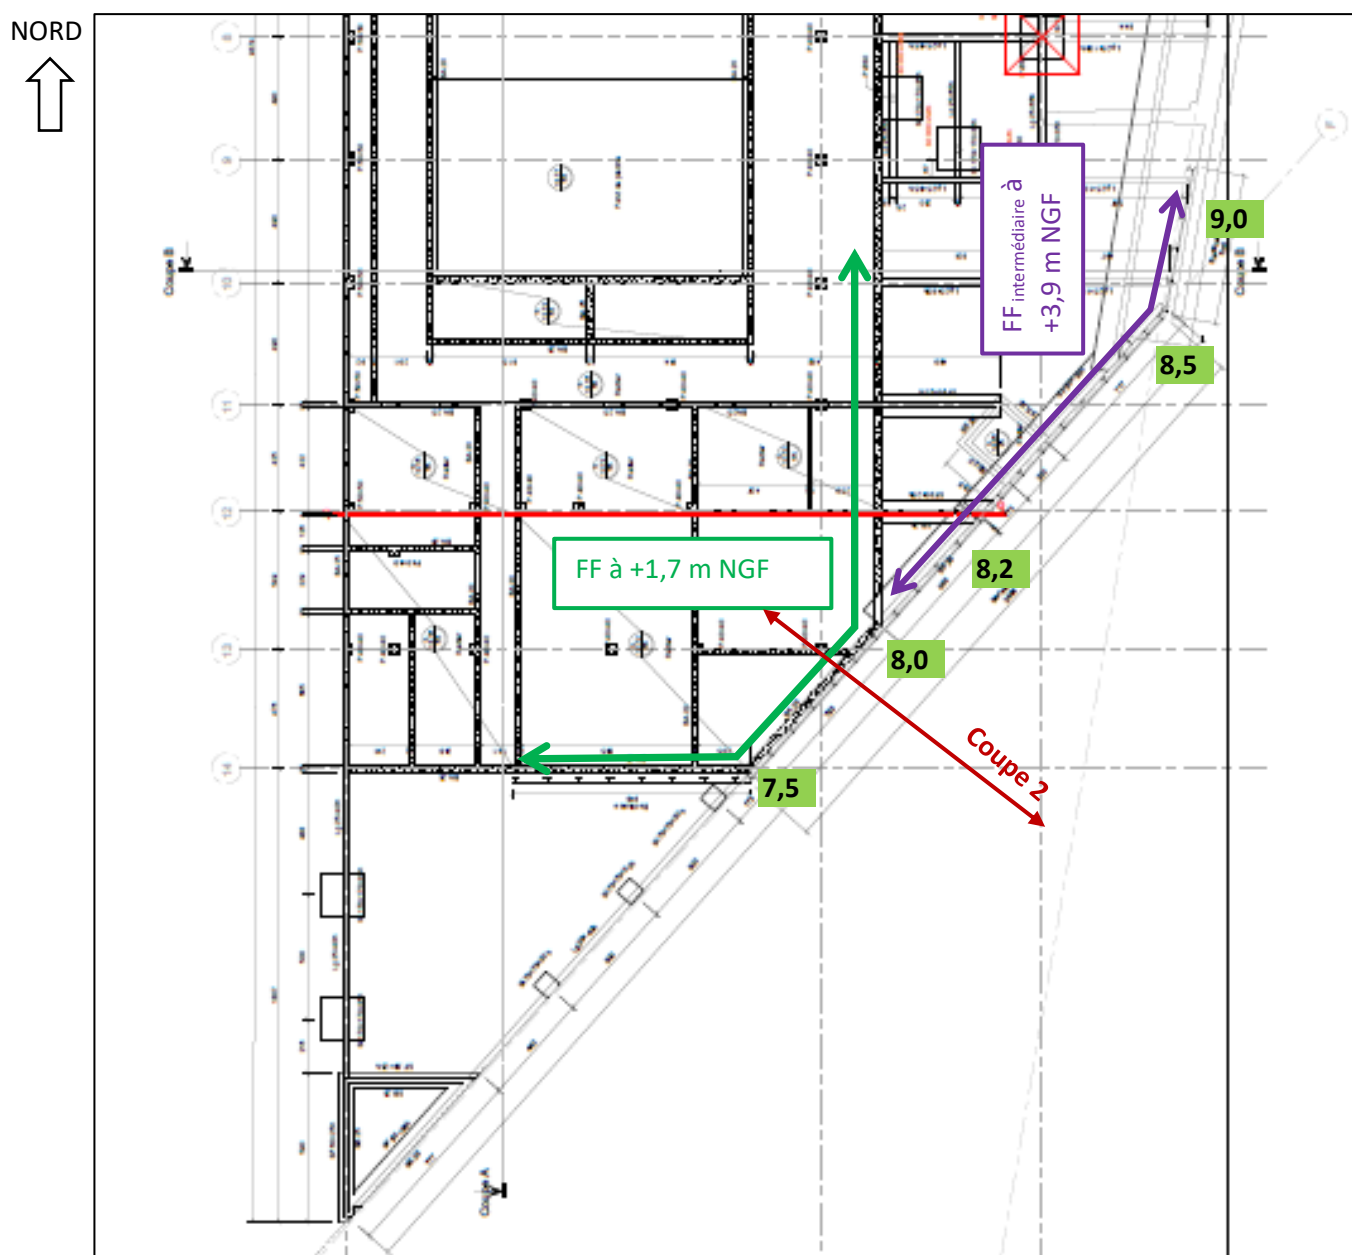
localisation de la coupe 2 sur plan de fondations n°2101 PRO de Mars 2025
